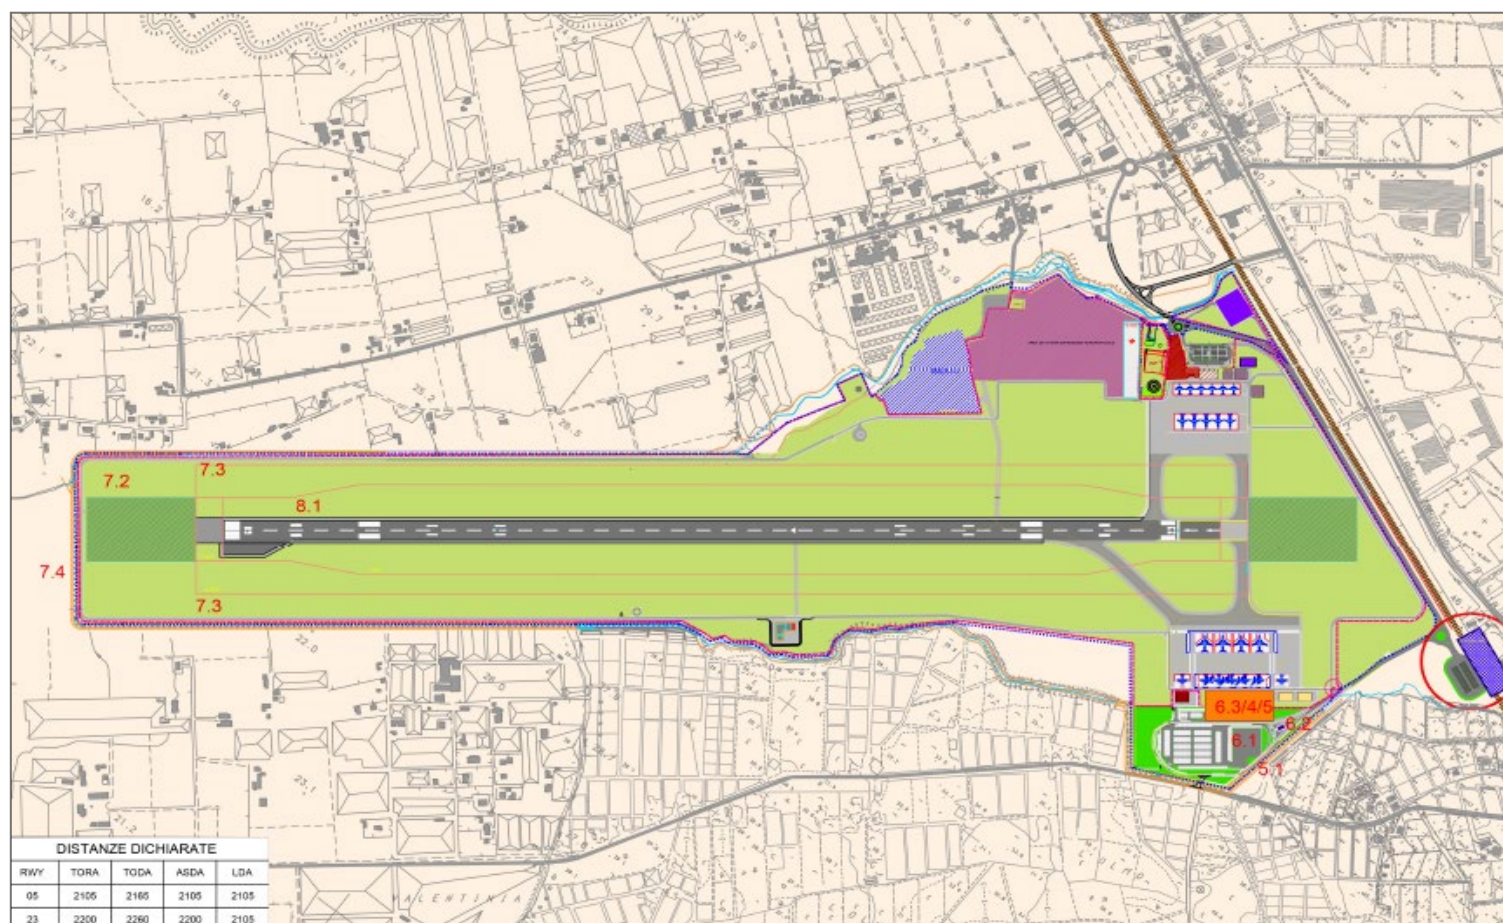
Planimetria degli interventi stato futuro (fonte Master Plan)
